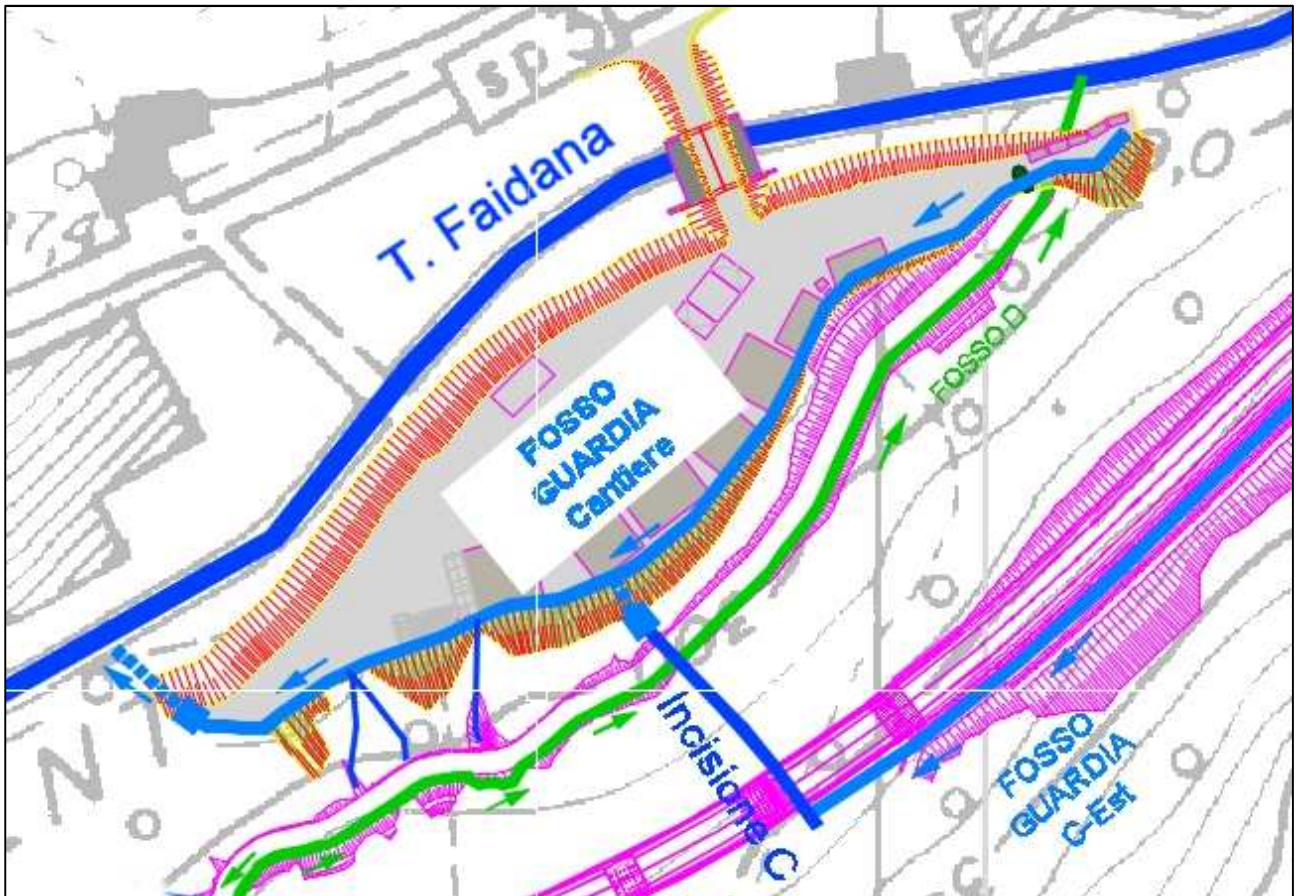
Canale guardia cantiere – Individuazione linee drenaggio (dopo la realizzazione delle viabilità principali e secondarie)
